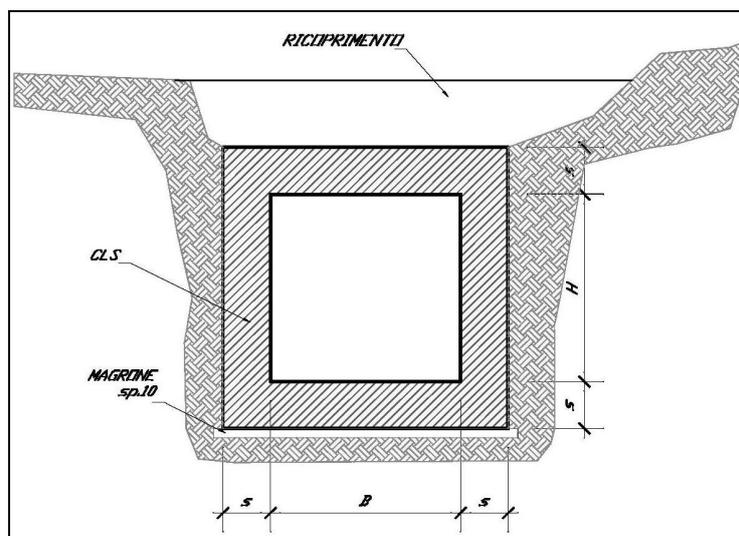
Inalvezione IN03 – Tombino di attraversamento: Sezione tipologica
